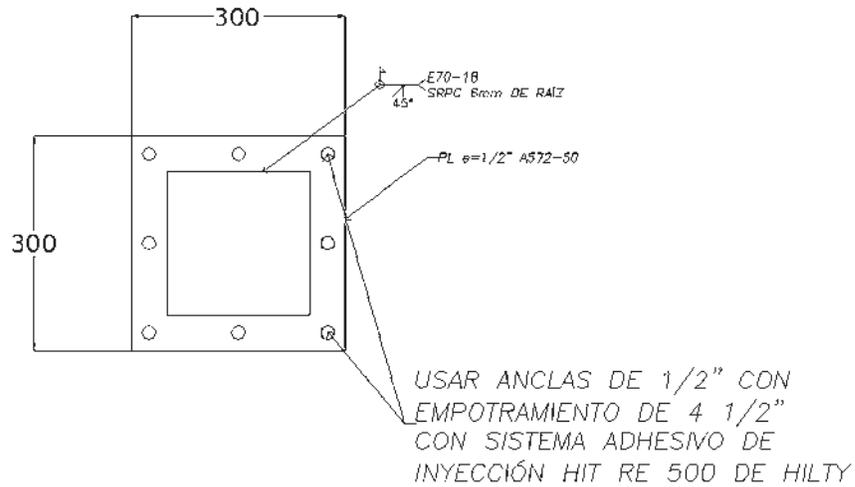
Detalle de la placa base donde se especifican los anclajes así como su geometría.
